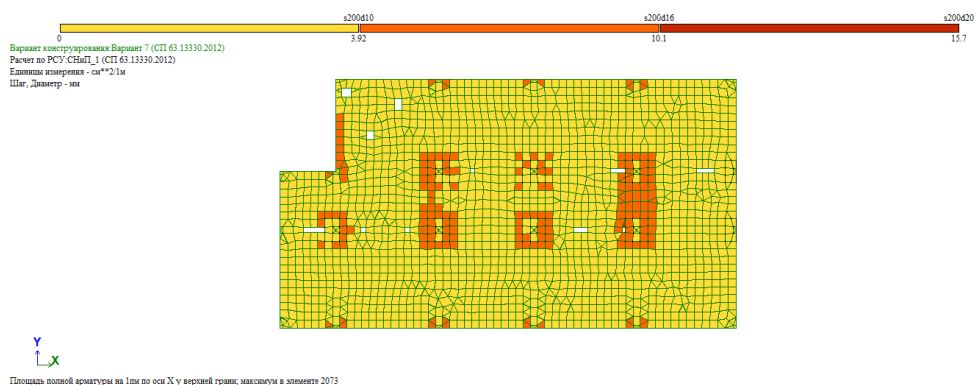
Армирование верхней зоны монолитной плиты по оси X
